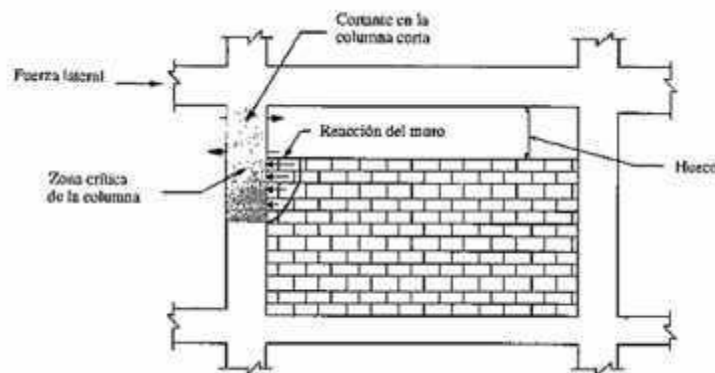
Falla de columna corta (vista en elevación), (Bazán y Meli, 2004).
